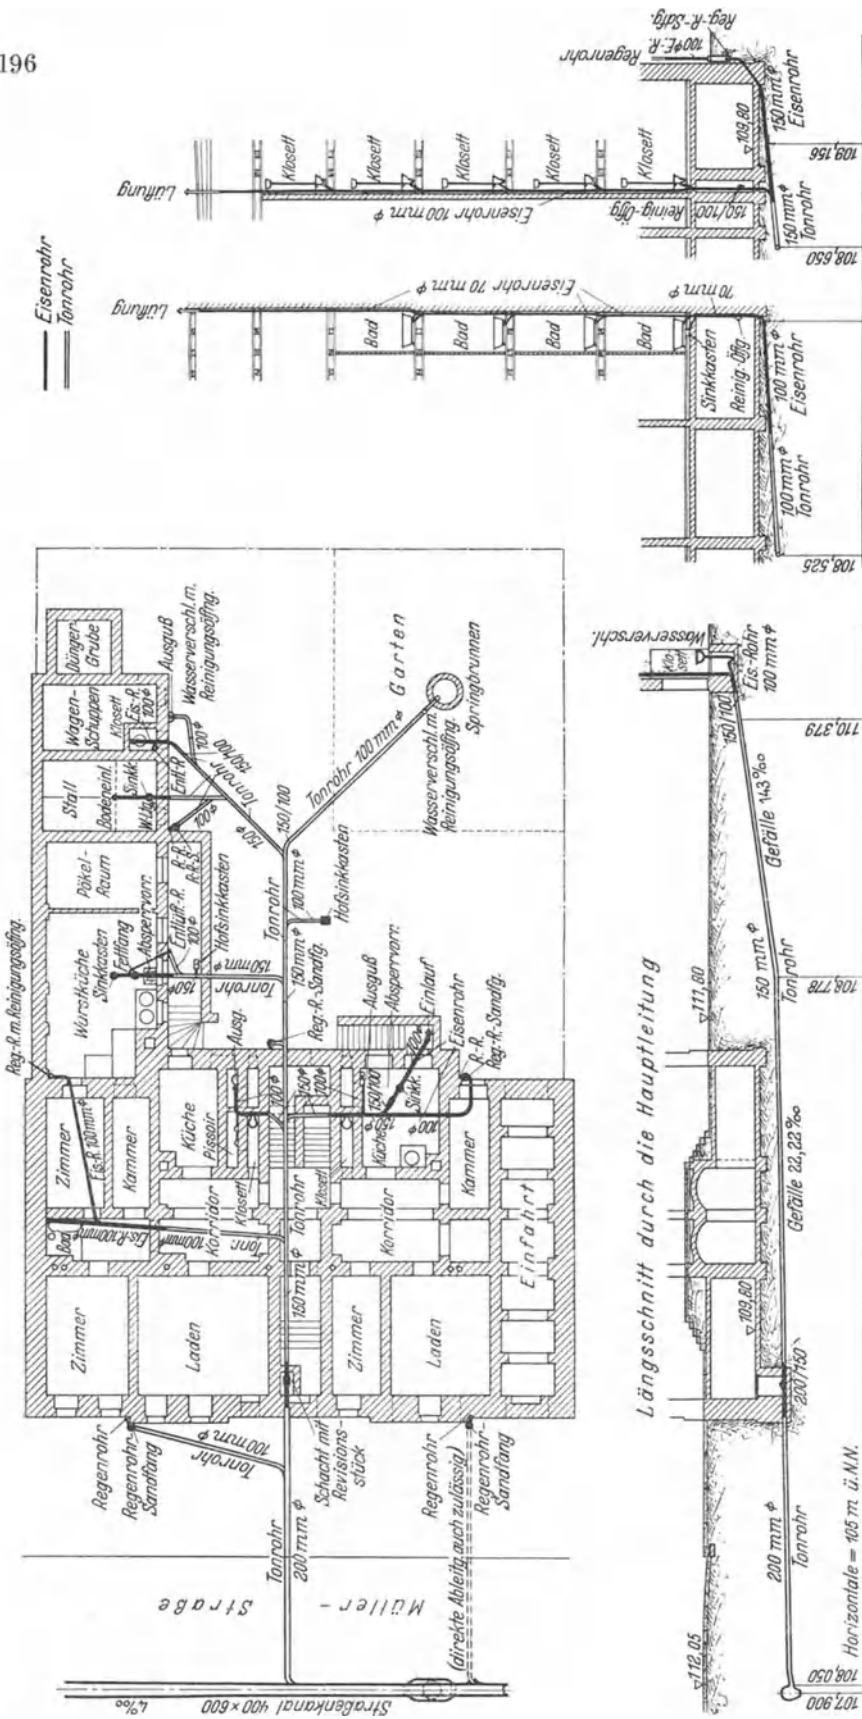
Grundstücksentwässerung im Mischverfahren.
